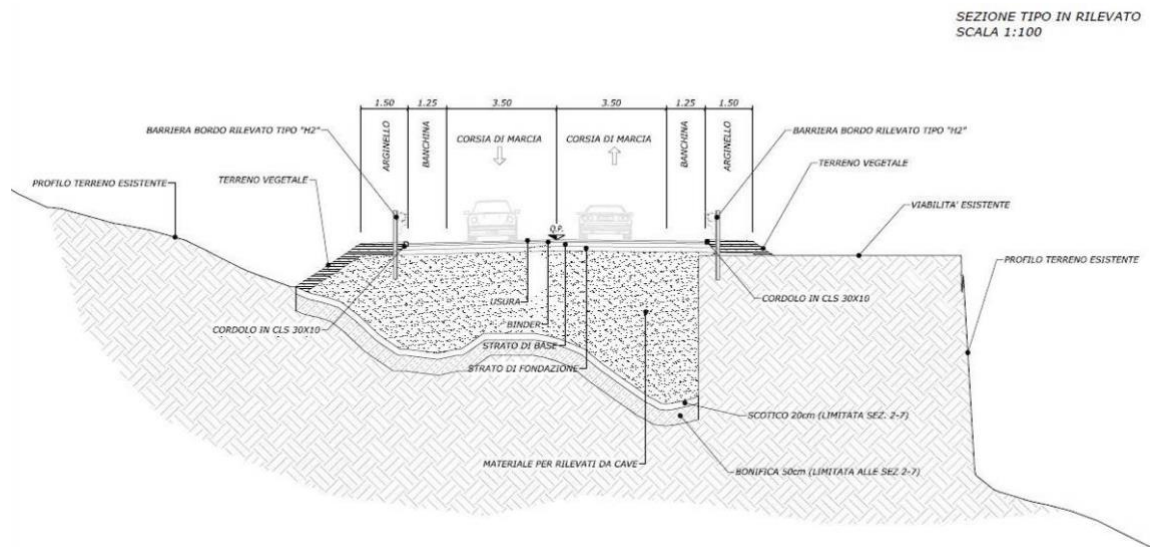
Sezione stradale di tipo C2 prevista per l'intervento in oggetto
